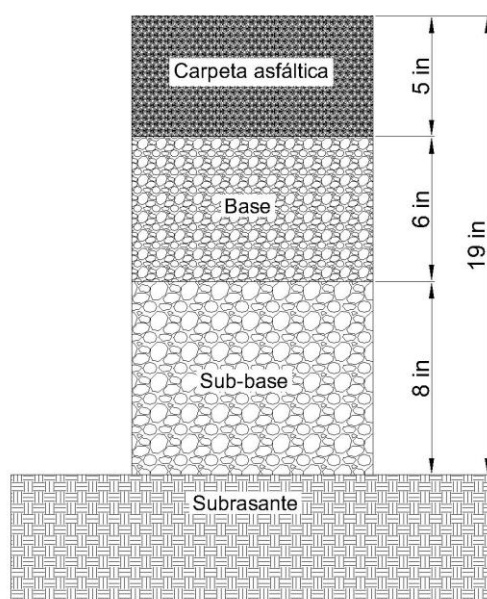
Estructura del pavimento original – ejemplo de aplicación
